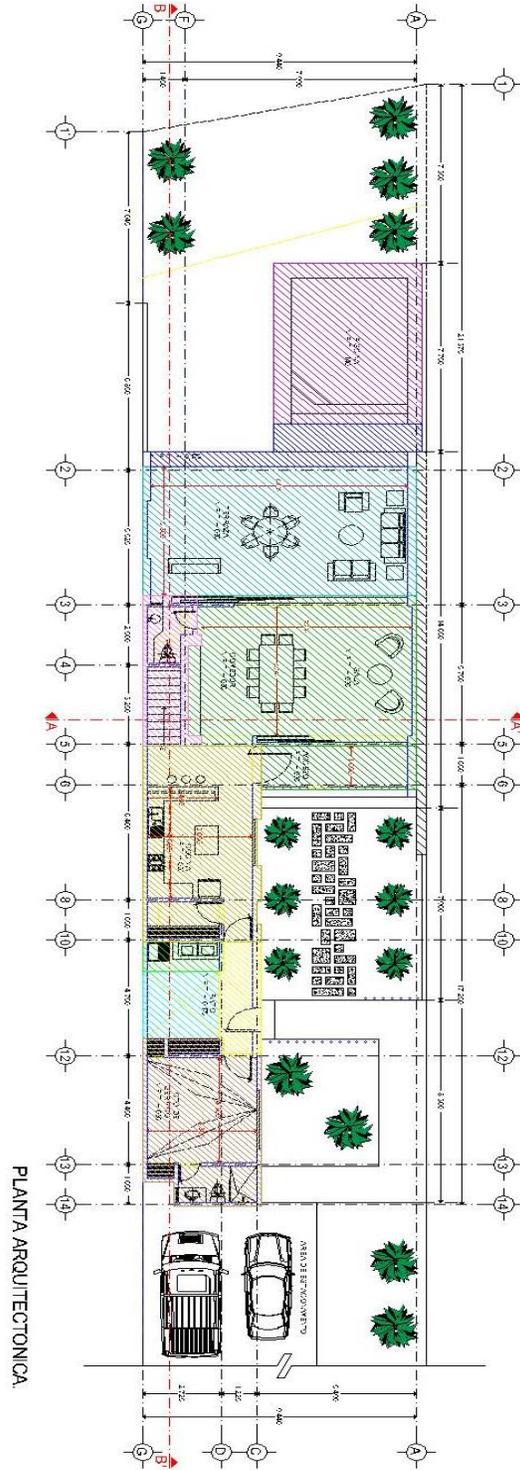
Vista general de la planta arquitectónica o desplante del proyecto y las áreas que lo componen.
